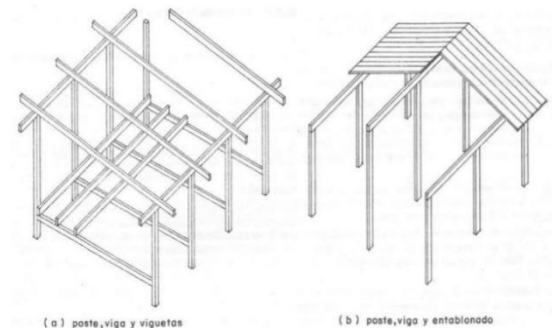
Sistema Estructura Poste y Viga. Desarrollo Constructivo.
